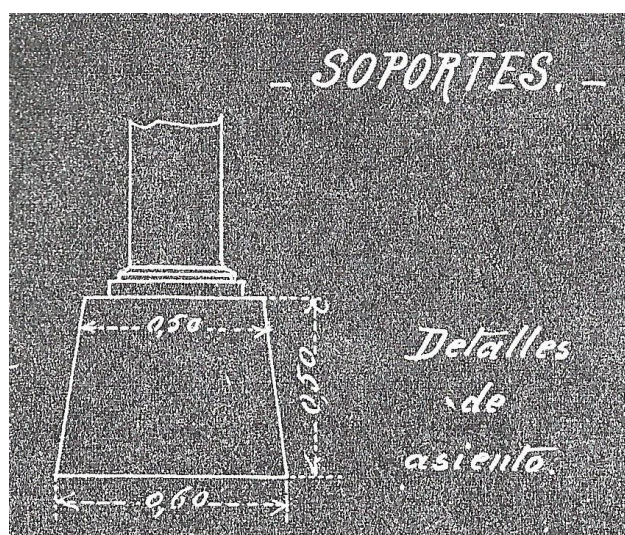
Croquis con medidas sugeridas para cimentación de columna de fundición. Fuente: (Anónimo, 1909).
